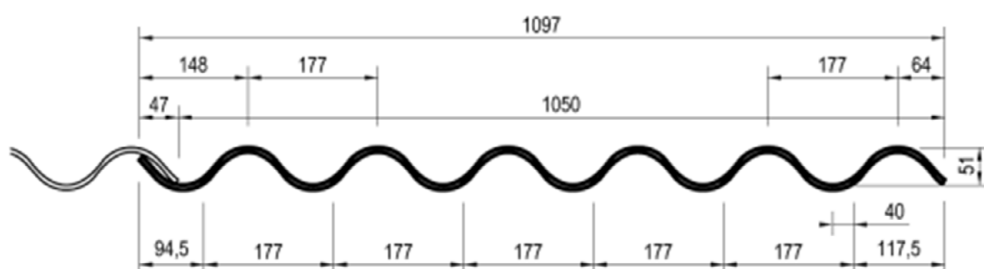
Wellplatte "BRIARWOOD LANDINI" (Profil 6) mit PP-Bändern; Querschnittsabmessung
